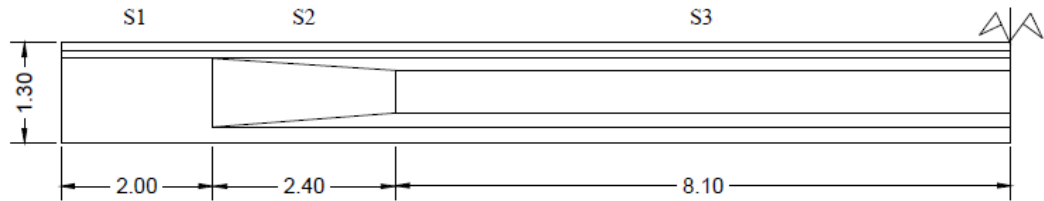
Vue en élévation de poutre de travée intermédiaire
